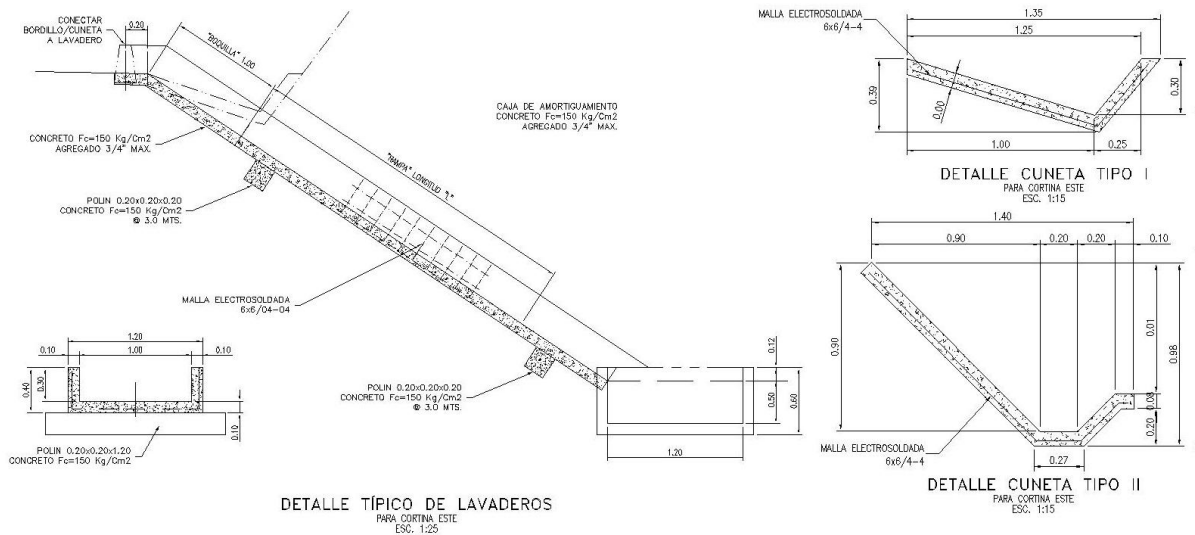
Detalle de las obras de drenaje en terraplén (lavaderos, bordillos y cunetas).
